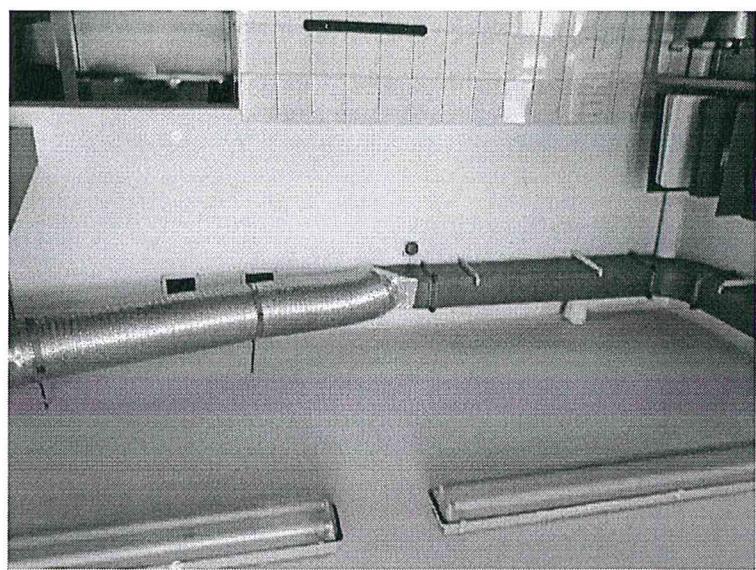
Kanat wyciągowy – widok w kierunku pionu.
